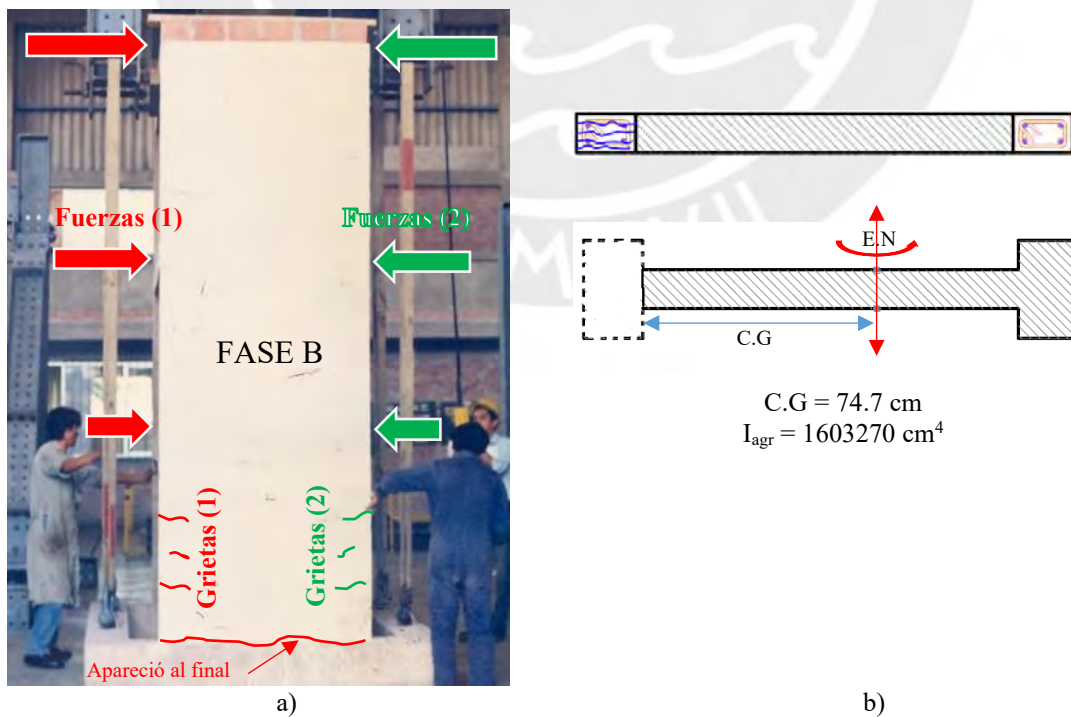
a) Patrón de daños en elevación., b) Sección agrietada
